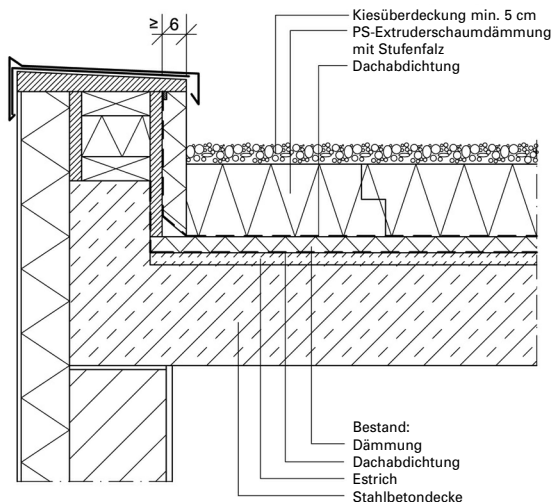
Dämmen der Attika bei einem bestehenden Gebäude
